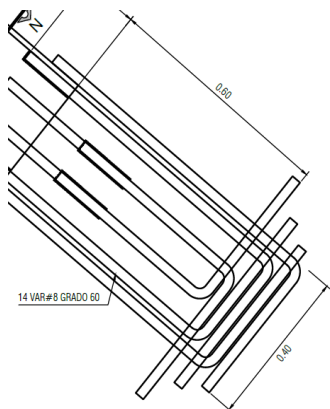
Detalle de la longitud de desarrollo (Planos constructivos, dimensión en m).
